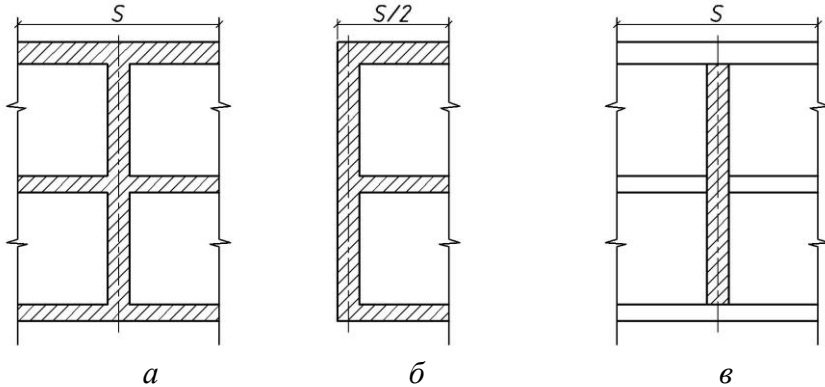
Розрахункові перерізи поперечних стін: *a, б* – при спільній роботі з поздовжніми стінами; *в* – за відсутності спільної роботи
